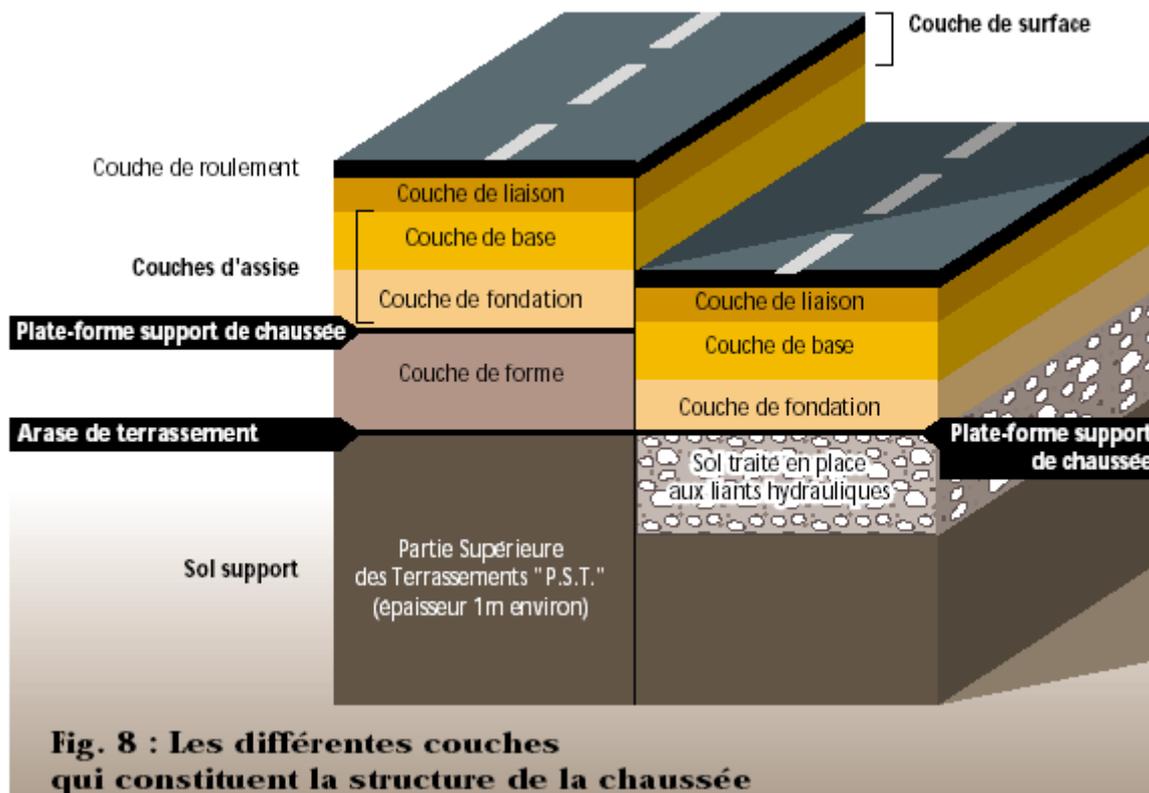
Les différentes couches qui constituent la structure de la chaussée
